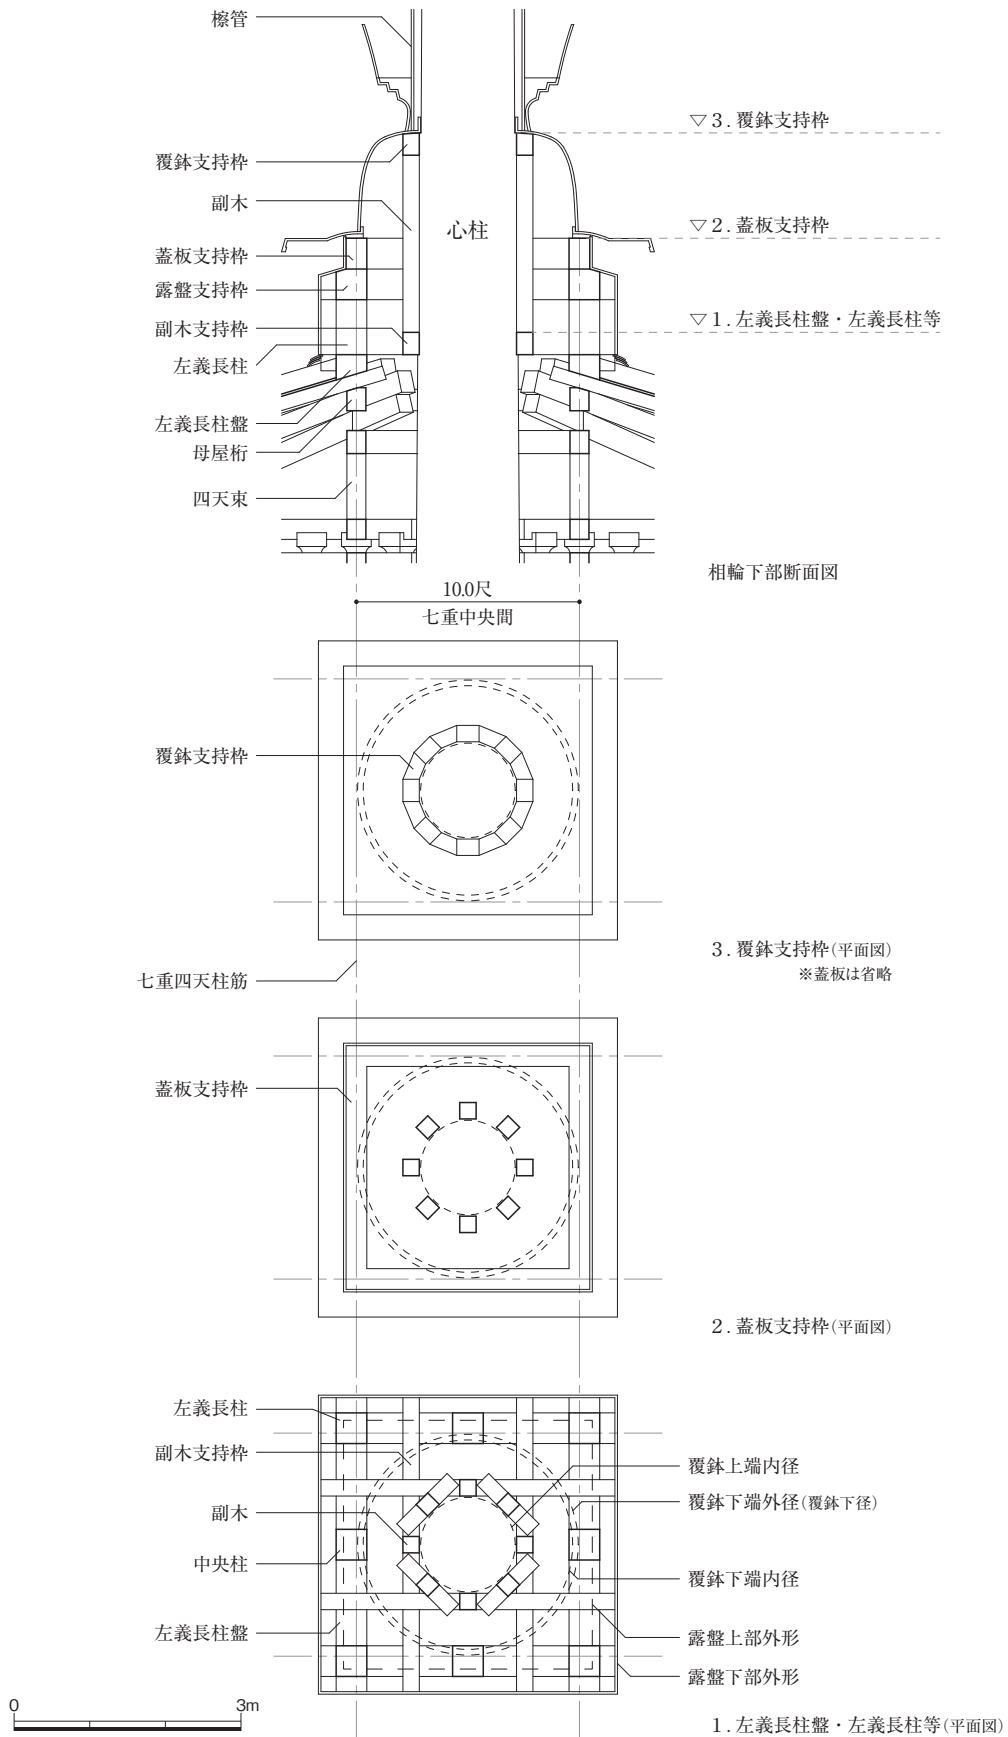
天平塔の相輪支持の構法 (部分平面・断面図) 1 : 100
